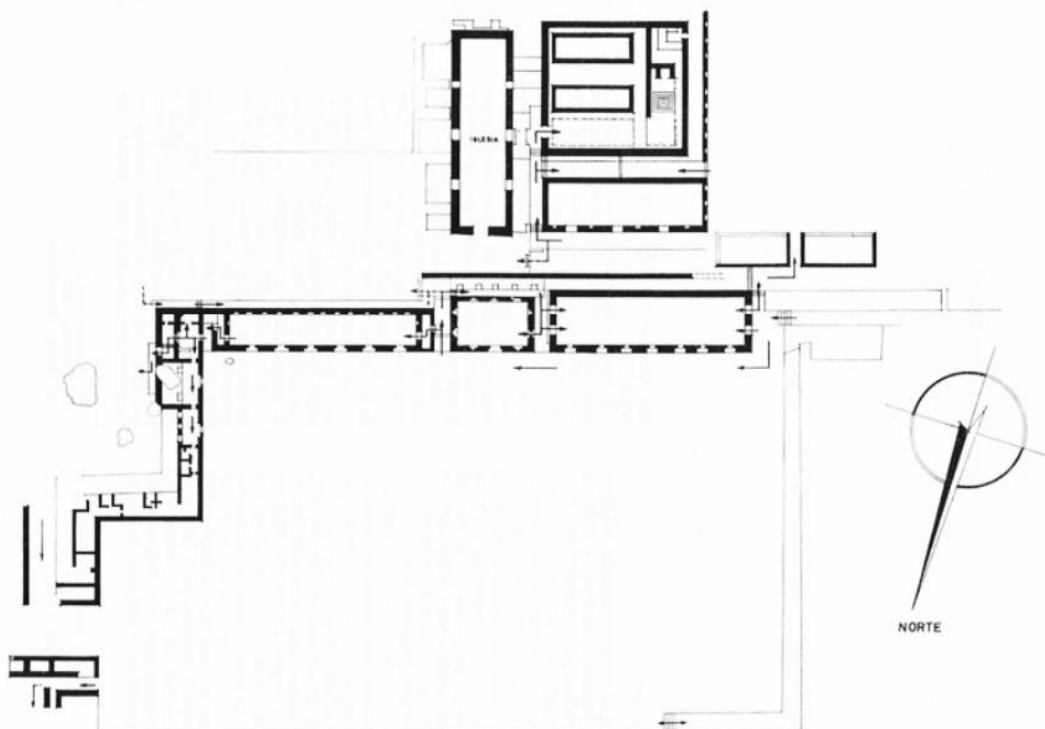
Croquis de las estructuras arquitectónicas de la excavación (Alcina 1976)
